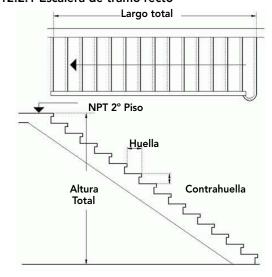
2: Planta y elevación de una escalera de tramo recto.
